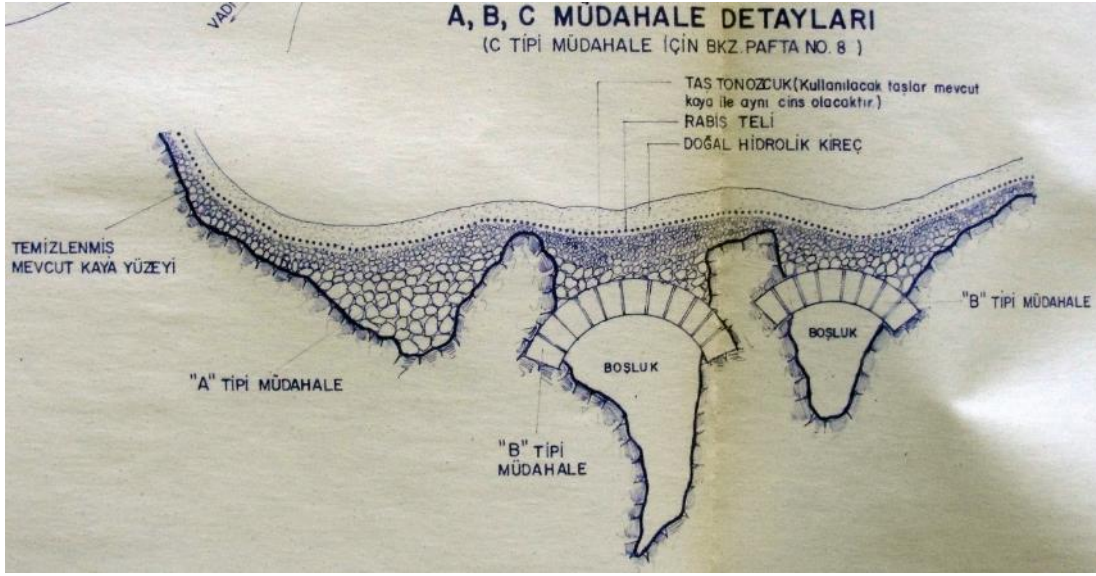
Sarica Kilise narteks doğu bölümünün yıkılan kubbeli üst örtüsüne ait müdahale detayı (NKK Arşivi).
